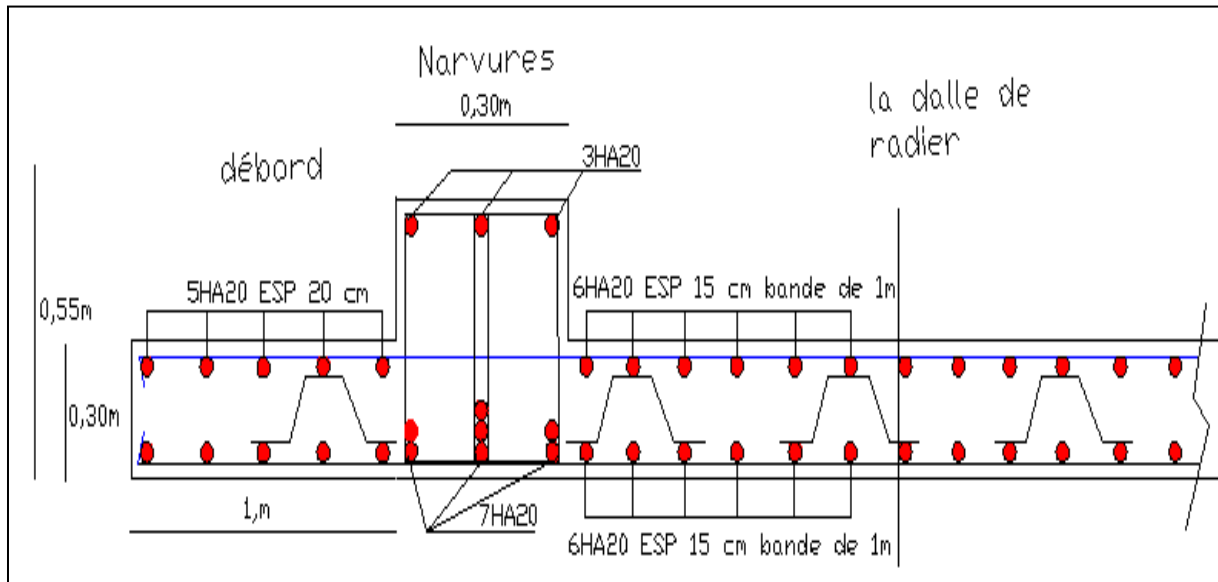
Ferrailage du radier générale sens X-X coupe en Appui
